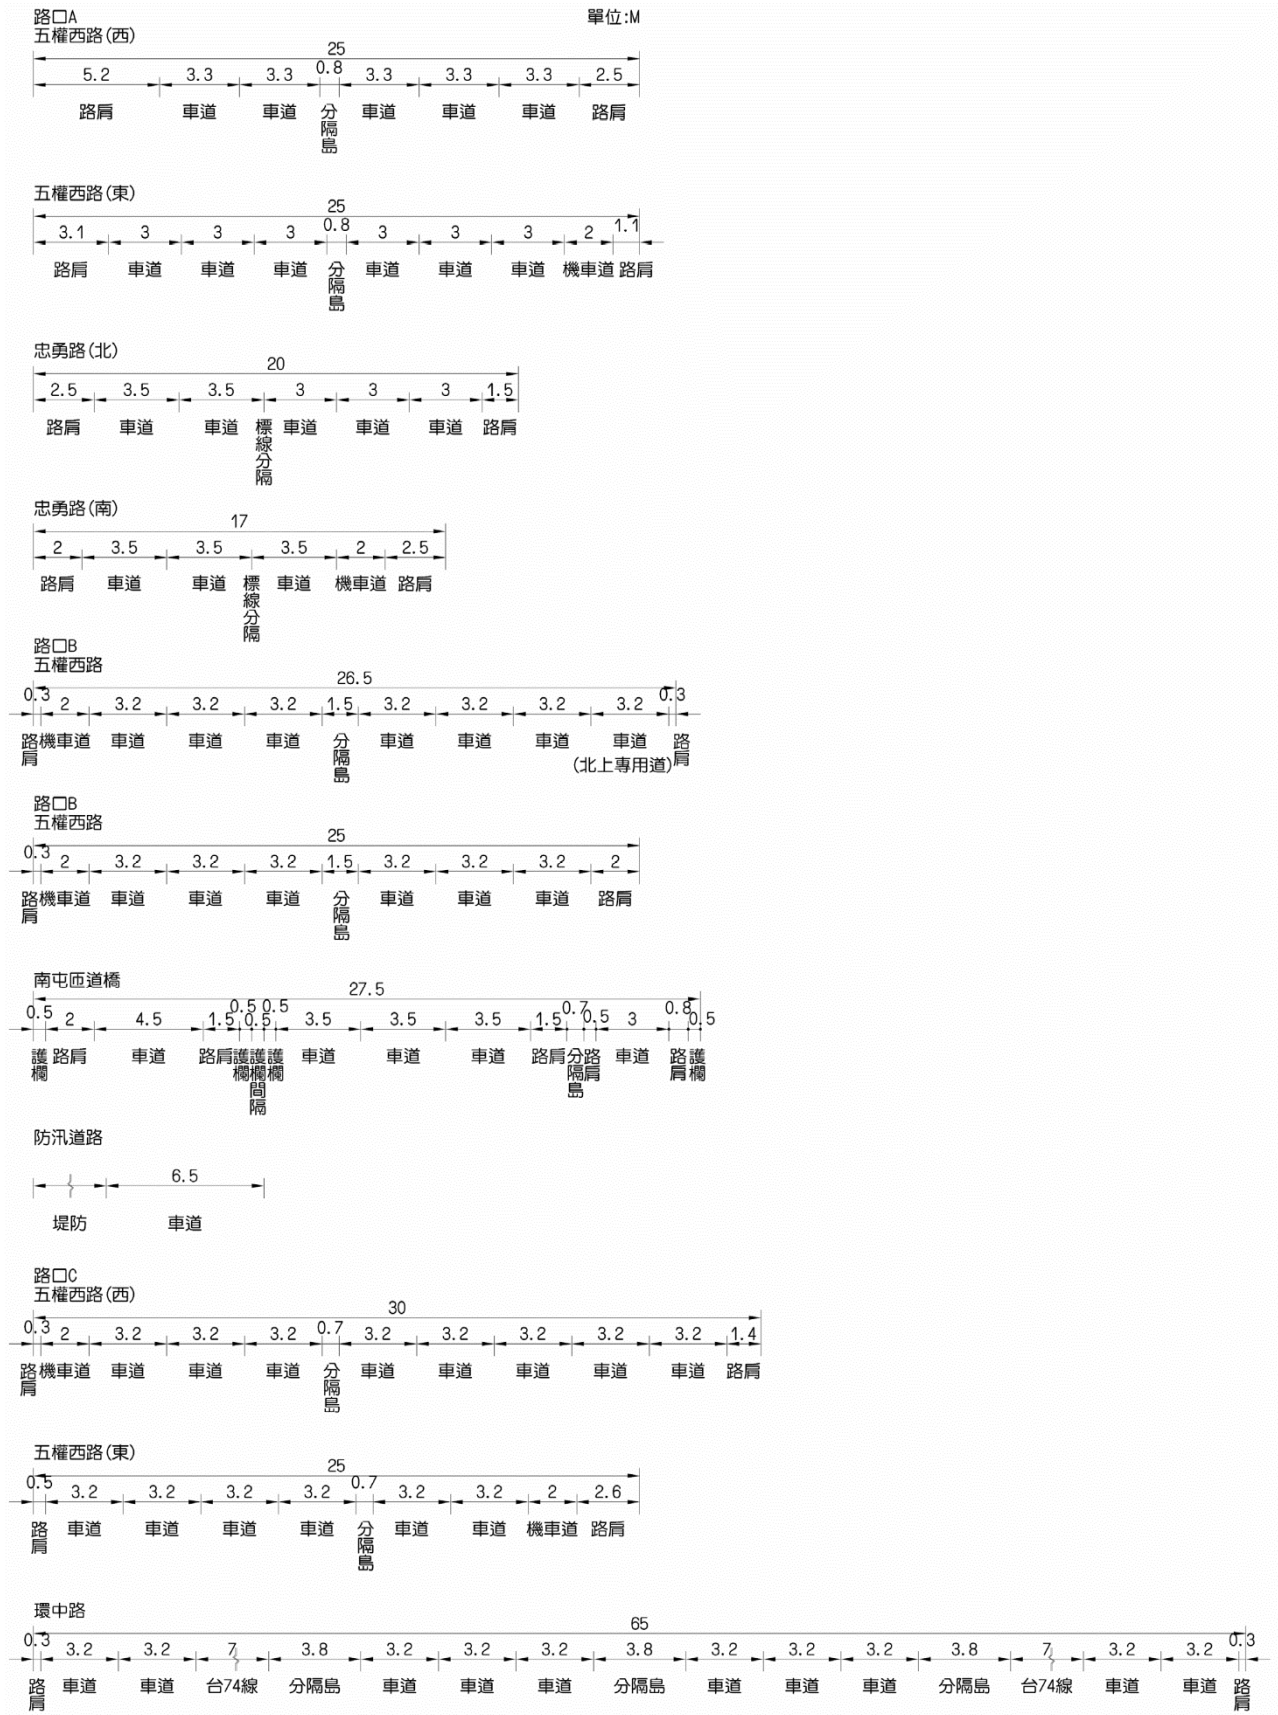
施工範圍鄰近交叉路口道路橫斷面圖
